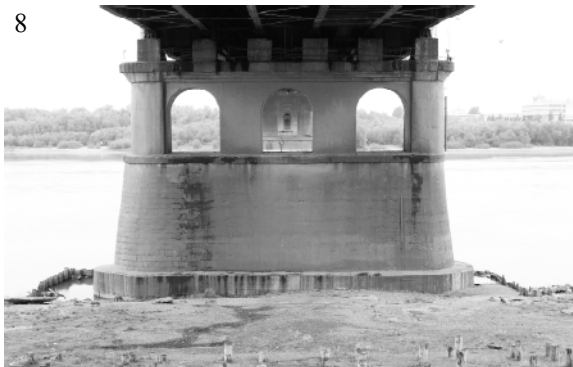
опора Ленинградского моста с открытым ростверком и стальным шпунтом при отметке 67,2 м; 9 – опора Комсомольского моста с открытым ростверком и деревянным шпунтом и открытая опорная часть набережной Оми при отметке 67,1 м; 10 – открытая опорная часть Иртышской набережной у академии МВД при отметке 67,1 м; 11 – открытая опорная часть причалов набережной Оми у площади Бухгольца при отметке 67,1 м; 12 – открытые отверстия водоприемника водозаборного сооружения бывшей ТЭЦ-1 в устье Оми при отметке 67,1 м; 13 – открытая опорная часть Иртышской набережной у бульвара Победы при отметке 67,2 м; 14 – урез воды в районе берегоукрепительных сооружений и водовыпуска у Ленинградского моста при отметке 67,1 м; 15 – опоры моста им. 60-летия Победы (метромоста) с открытым ростверком при отметке 67,1 м
